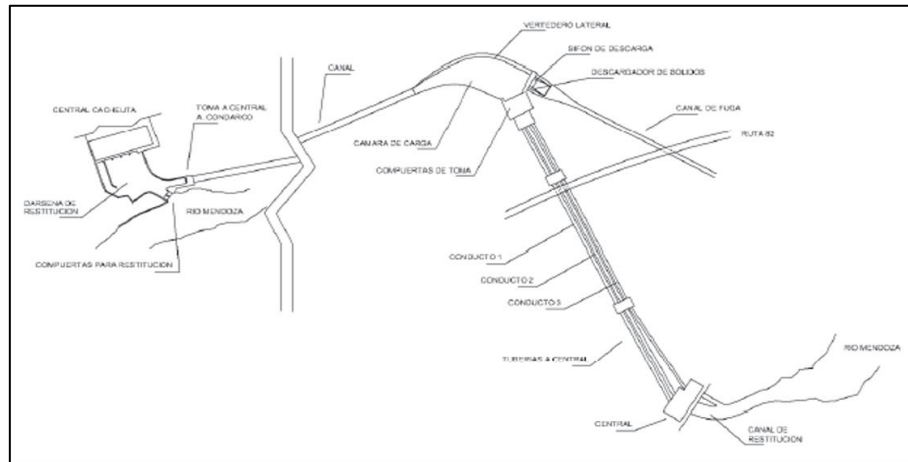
Planta esquemática del complejo Álvarez Condarco.
